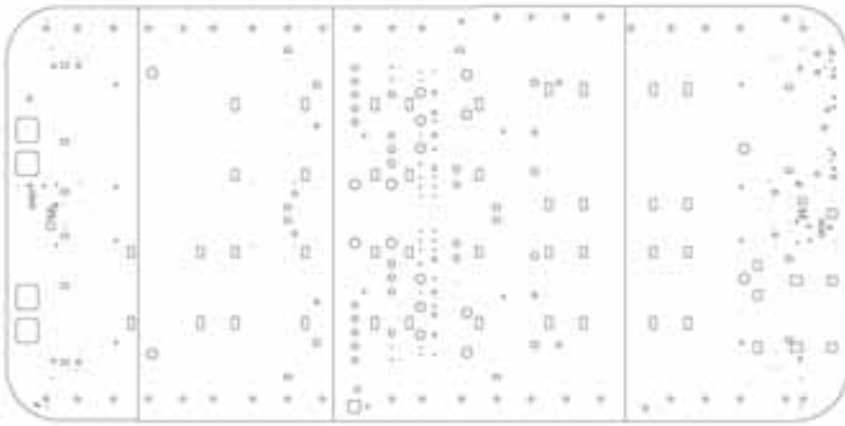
Planta de la estructura con situación general de embebidos, pasatubos y bocas de acceso en la losa superior.
